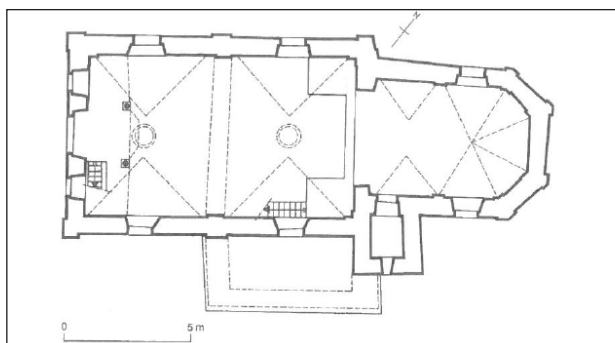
Grundriss der Kapelle (aus [1])
